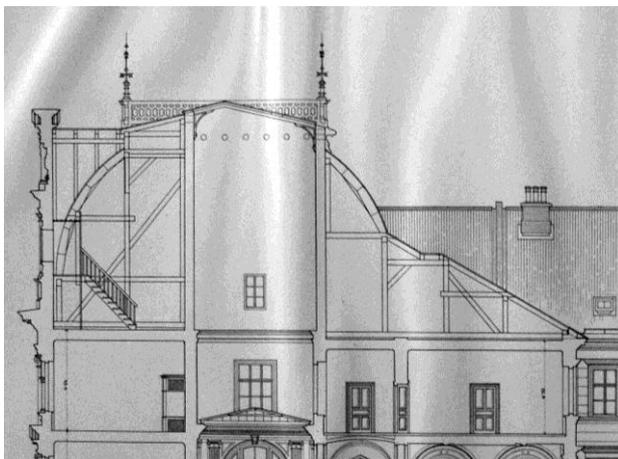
Schnitt durch das 2. Obergeschoss und das Dachgeschoss
